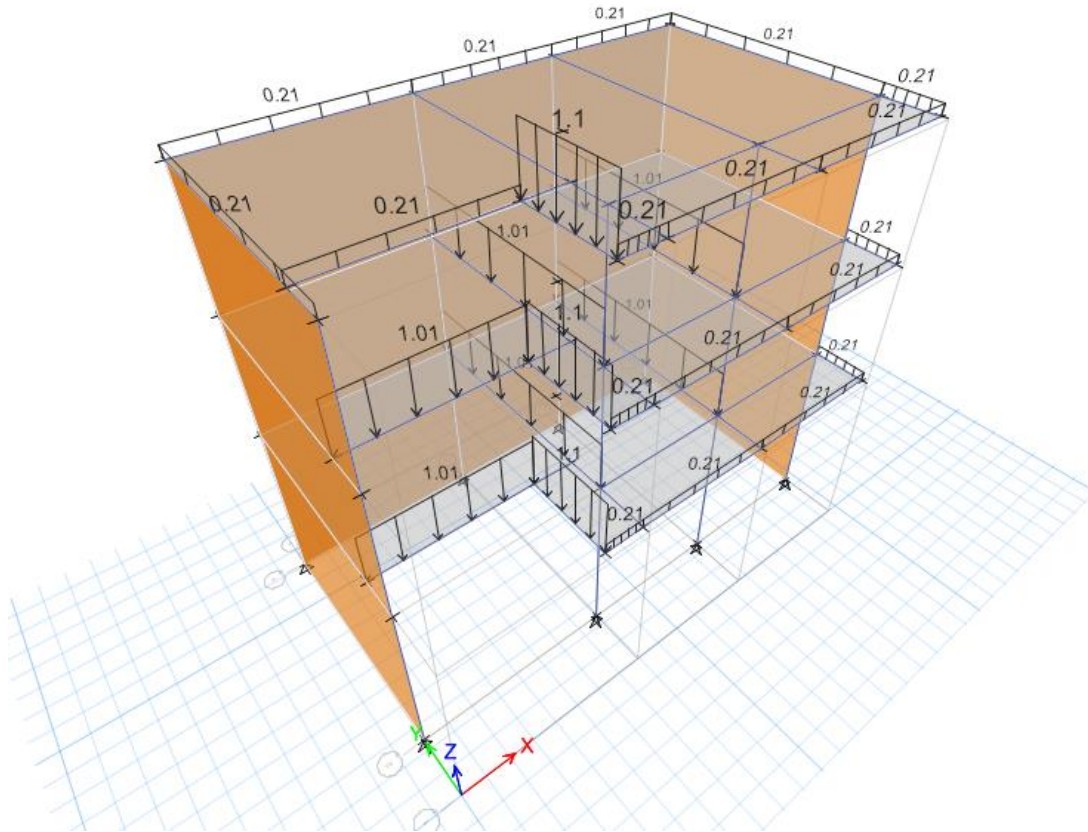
Modelamiento de vivienda rigidizada en Software Etabs.
